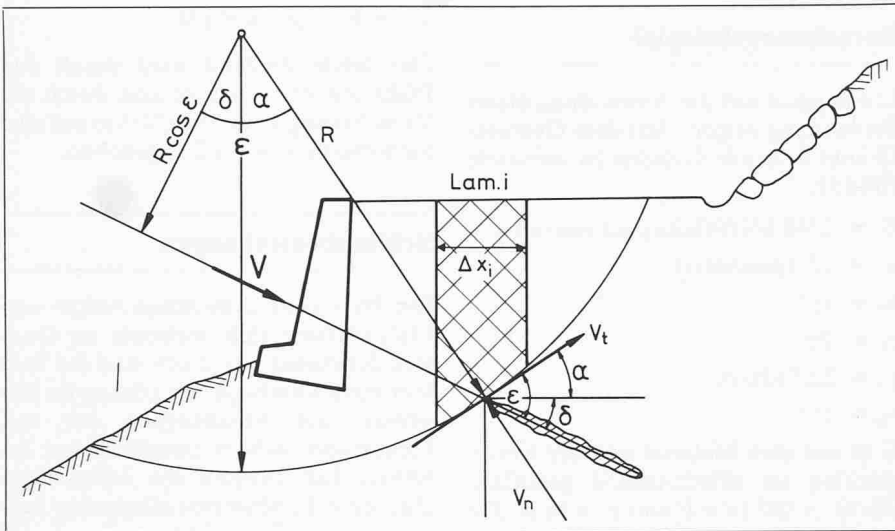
Gleitfläche, Anker und Schnittkräfte
